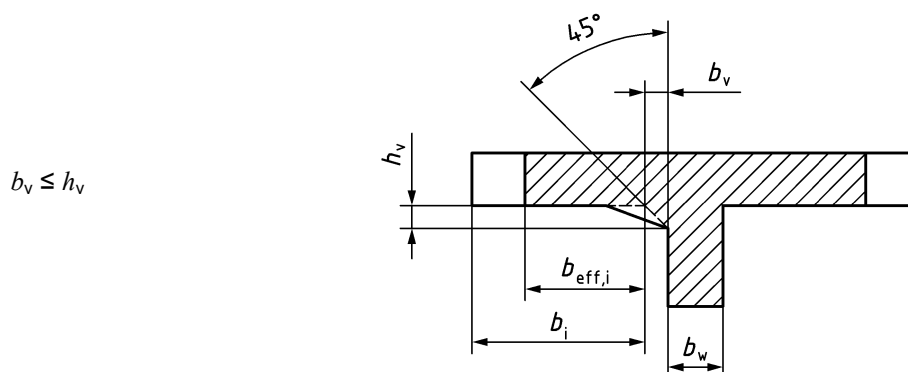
Wirksame Stegbreite $b_w + b_v$ bei Gurtplatten mit Vouten
